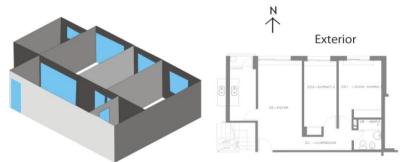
Modelo simplemente orientado y planta tipo de la tipología real . Fuente: Picción, et al 2008
